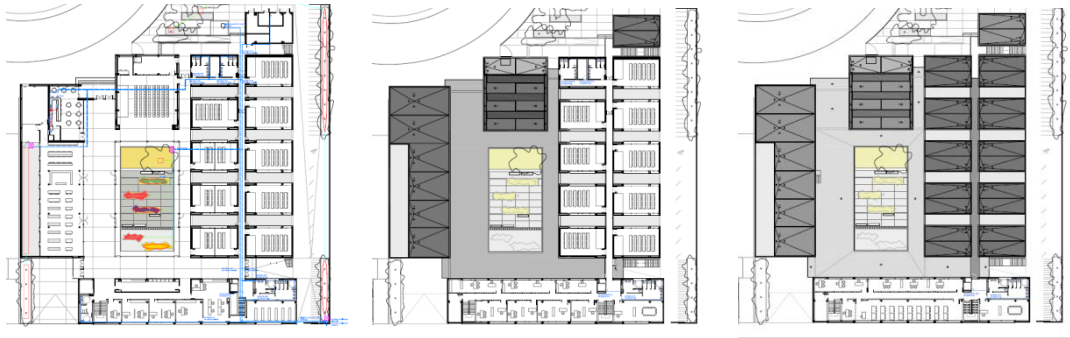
Planos de instalación de fontanería del proyecto de ejecución. (AST Ingenieros).
